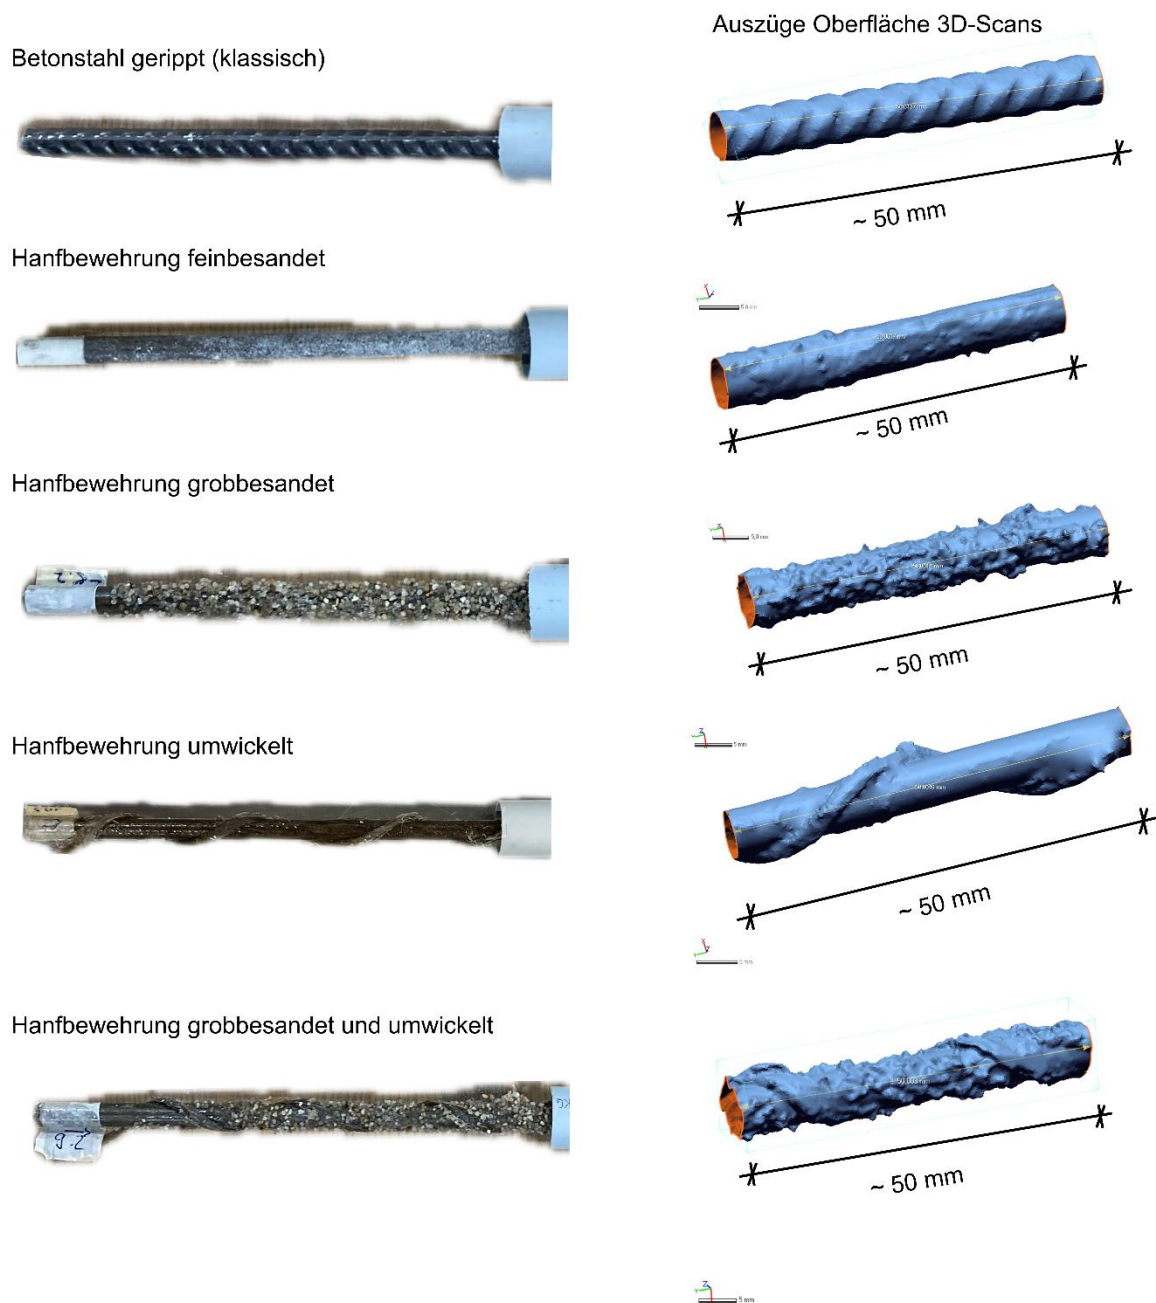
Darstellung der Referenzbewehrung Betonstahl und der profilierten Hanfbastbewehrungsstäbe und den korrespondierenden Oberflächen der 3D-Scans (schematisch)
